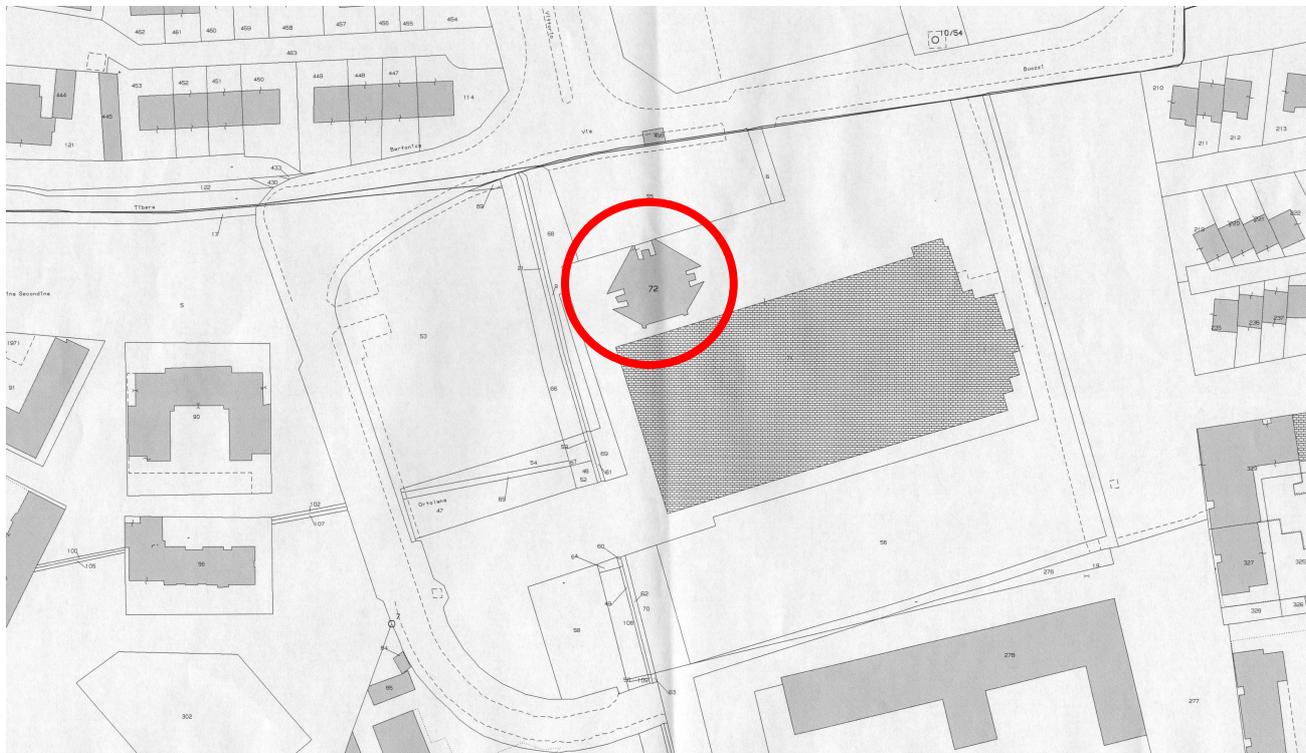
Estratto di planimetria catastale, foglio 55, particella 72
